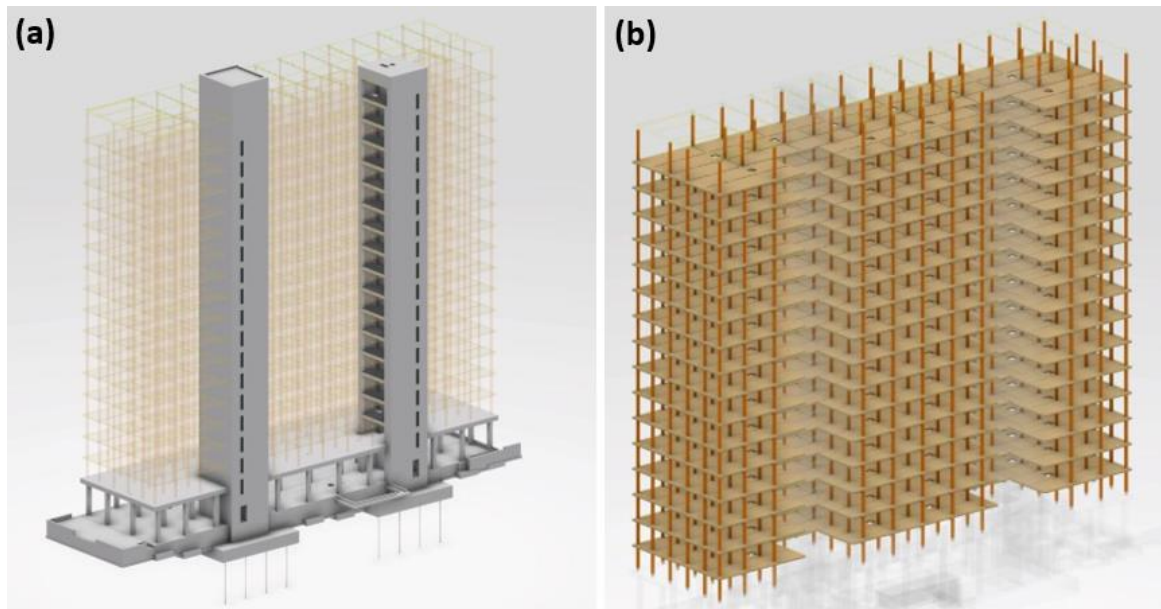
Edificio Brock Commons: (a) Primer piso y muros centrales de hormigón armado; y (b) marcos de madera tipo Glulam y paneles de CLT [65].
